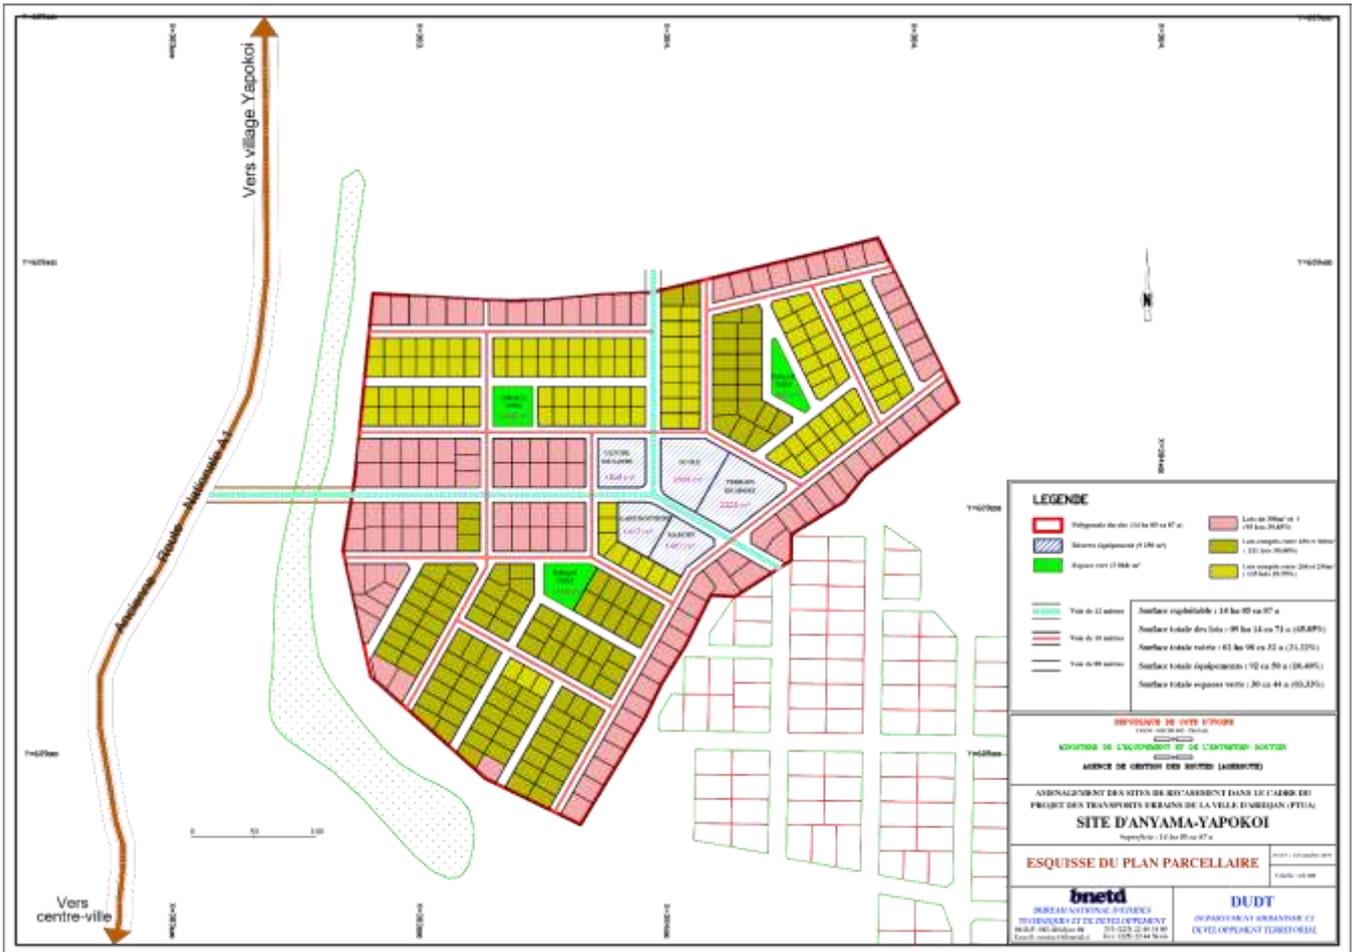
Type d'aménagement du site d'Anyama Yapokoi
